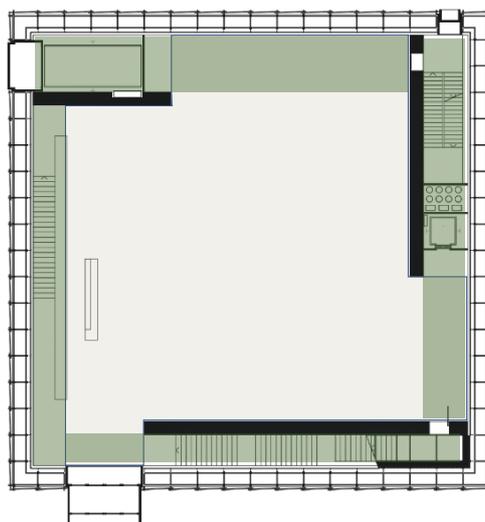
Planta esquemática do *Kunsthaus Bregenz
